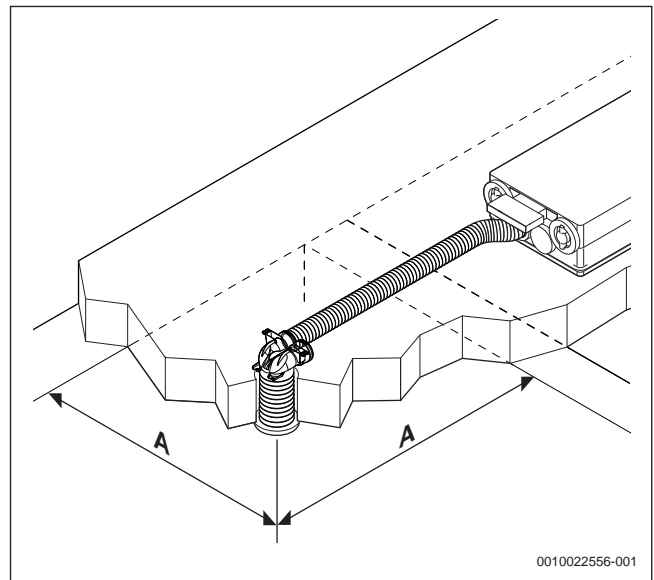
Distanze minime dalle pareti per valvola a soffitto
